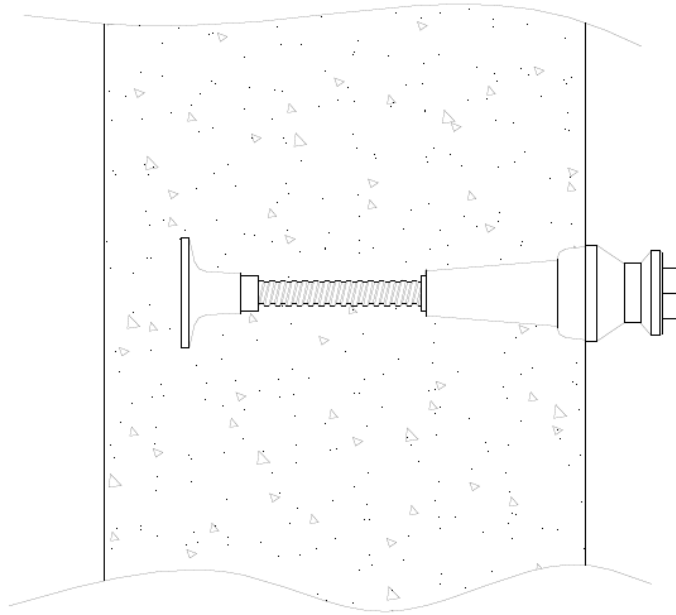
Perfil idealizado del sistema de anclaje para encofrado tipo trepante. Recuperado de: Ulma Construction, *Anclajes. Sistema de anclaje consola trepado.
